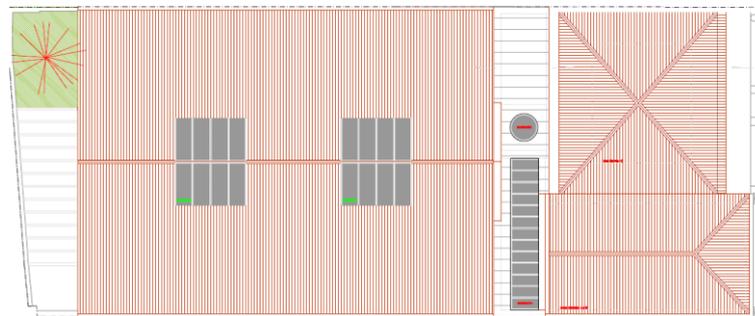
Planta da Cobertura (Cumeeira 118,75 m)
